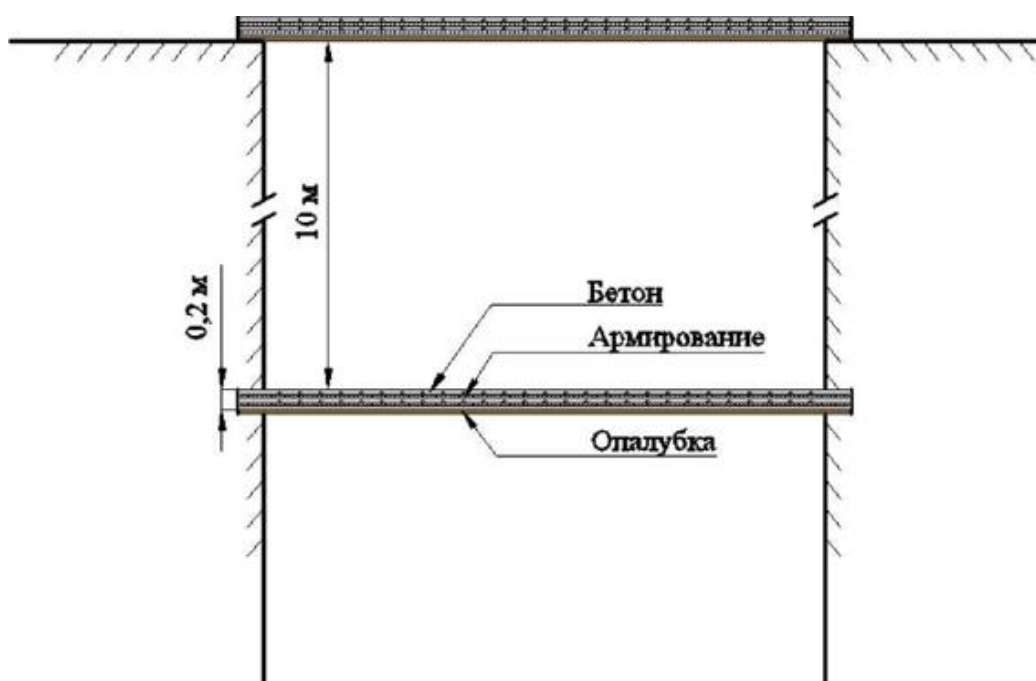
Схема установки железобетонной перемычки на устье ВХВ
